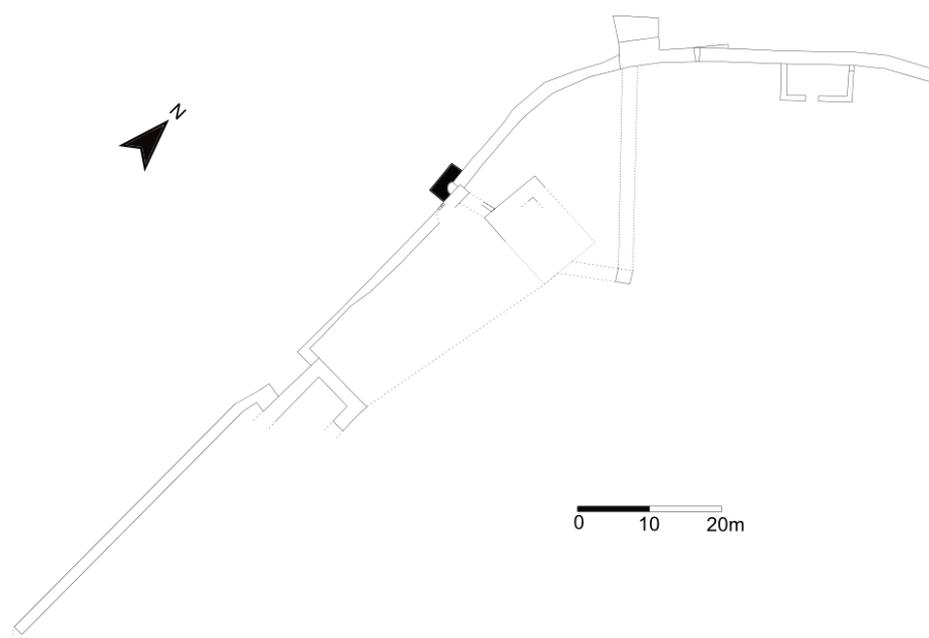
Planta do castelo de Alenquer na fase 3b.
